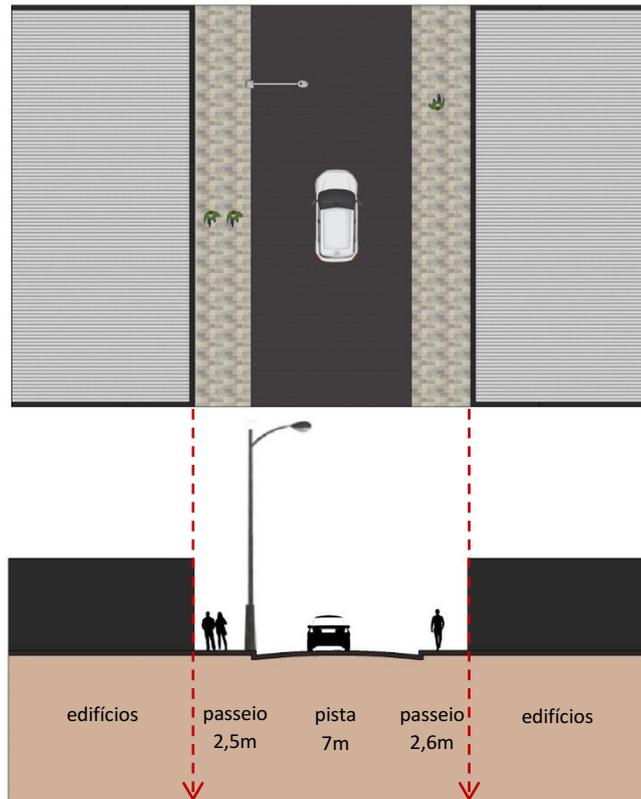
Planta e perfil viário AA da R. Ponto Chic. Fonte: Desenho do autor, 2020.
